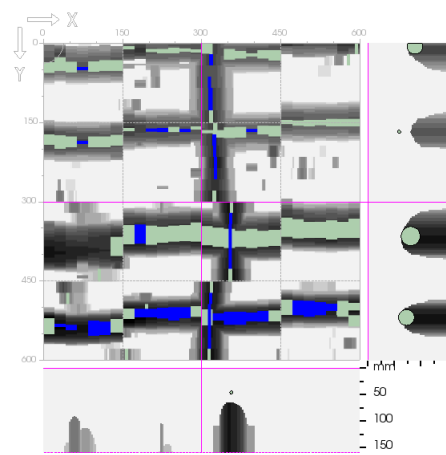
Poutre Pt05 – Travée 2 à mi-travée
